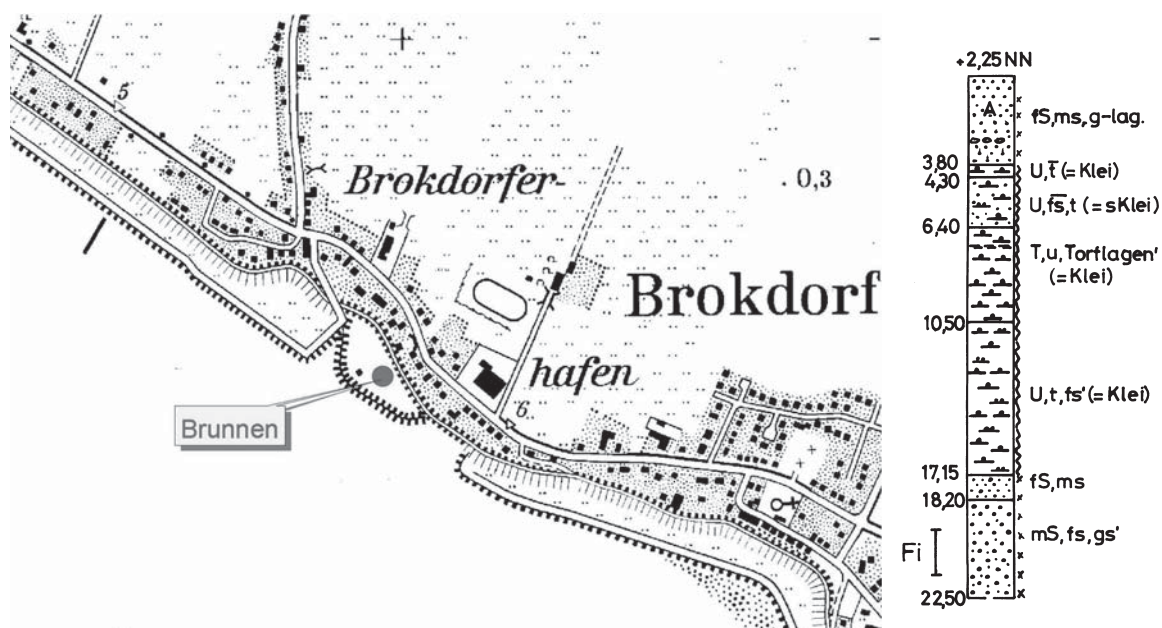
Lageplan und Bohrprofil mit Lage der Filterstrecke am Deichsiel Brokdorf
